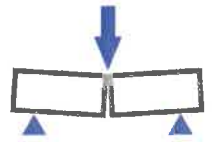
Außermittiger Bruch, Querschnittsansicht
